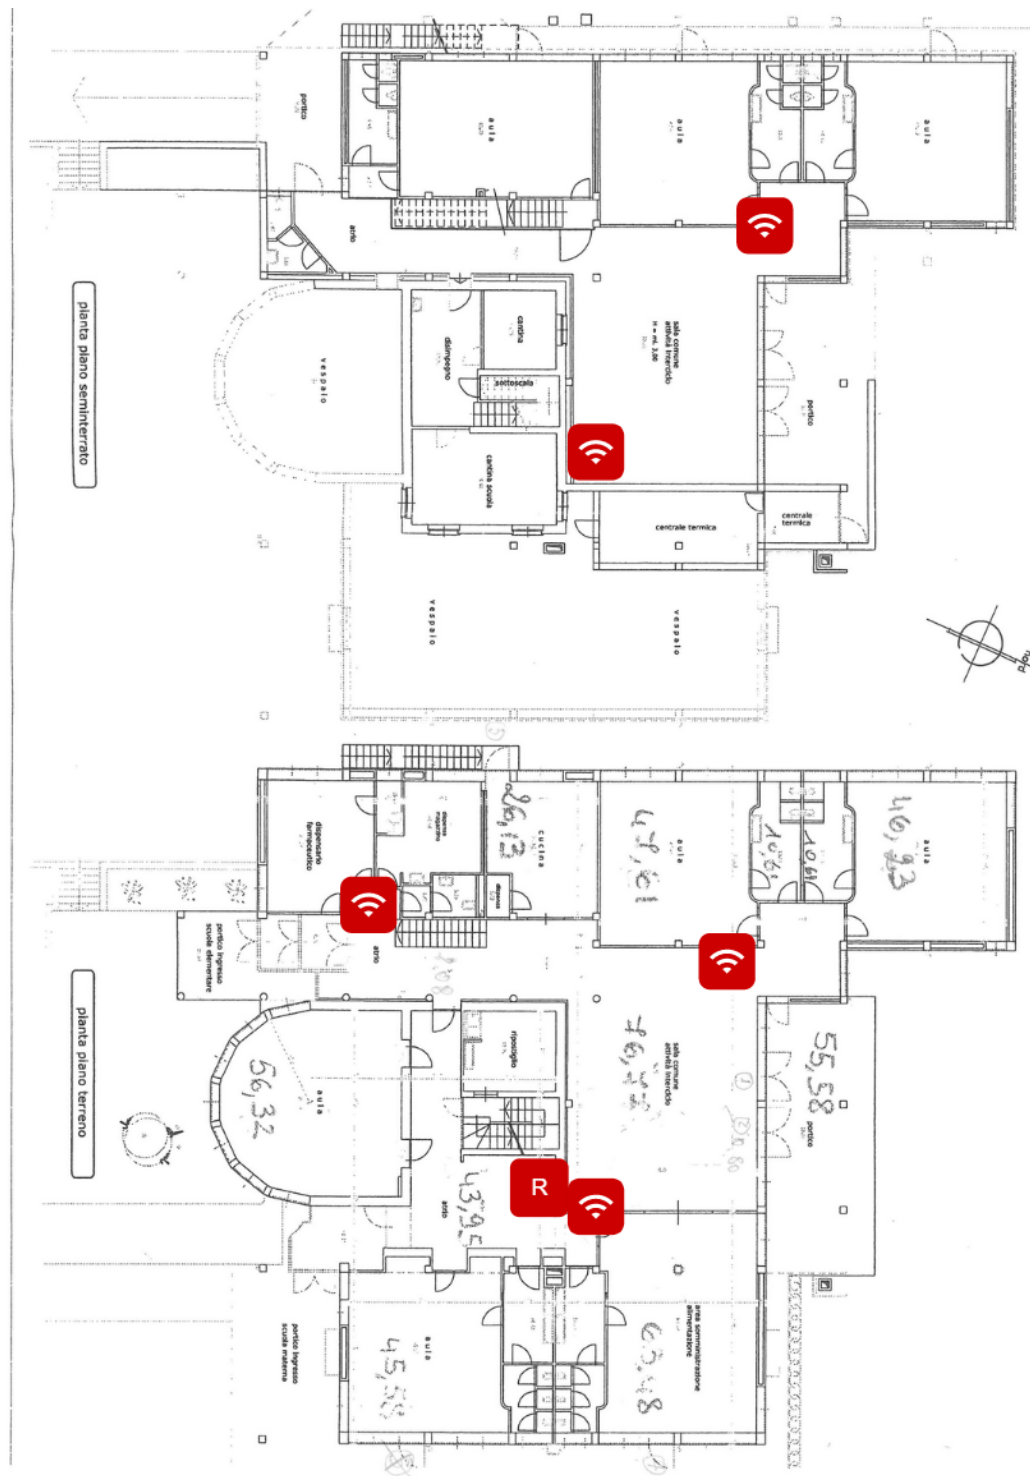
Planimetria Scuola dell'Infanzia di Castelnuovo Bozzente
